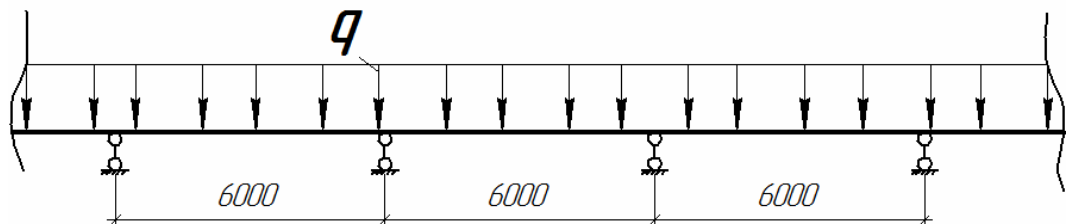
Розрахункова схема монолітної залізобетонної плити
